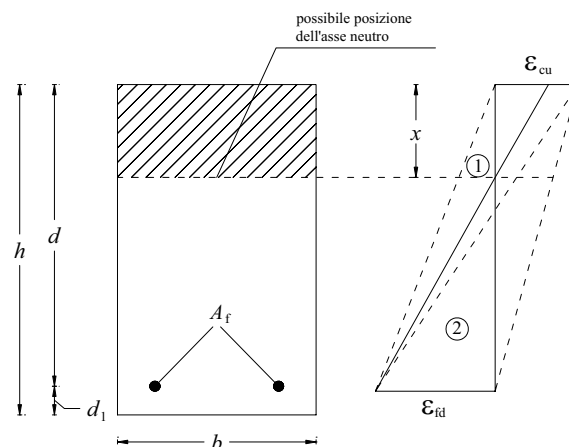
Modalità di rottura di una sezione di calcestruzzo armato con barre di FRP.
